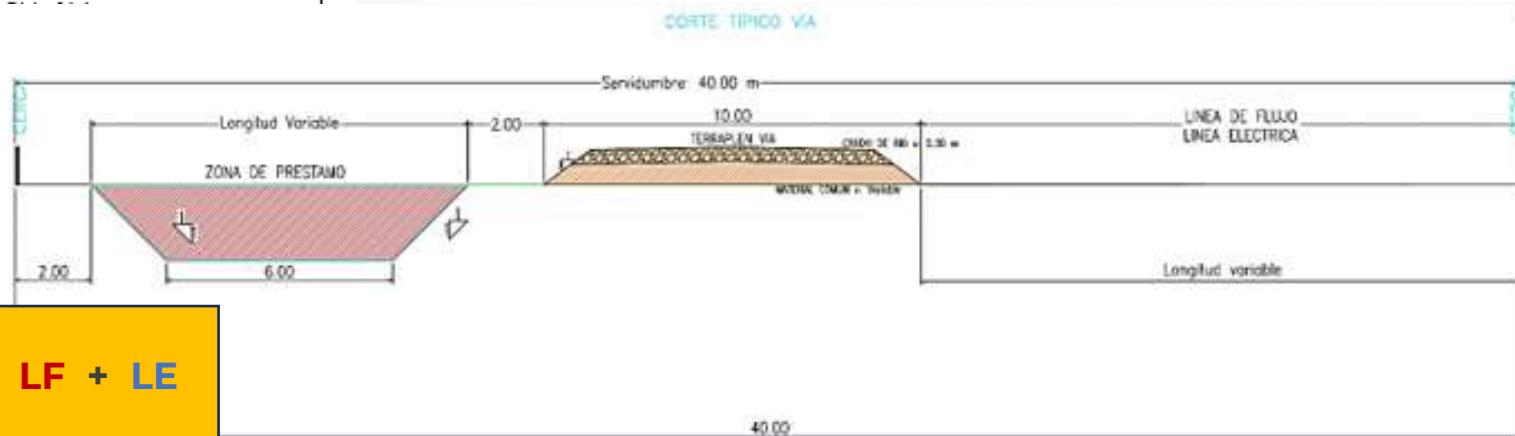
Corte típico de vías en terraplén con DDV Mixto
